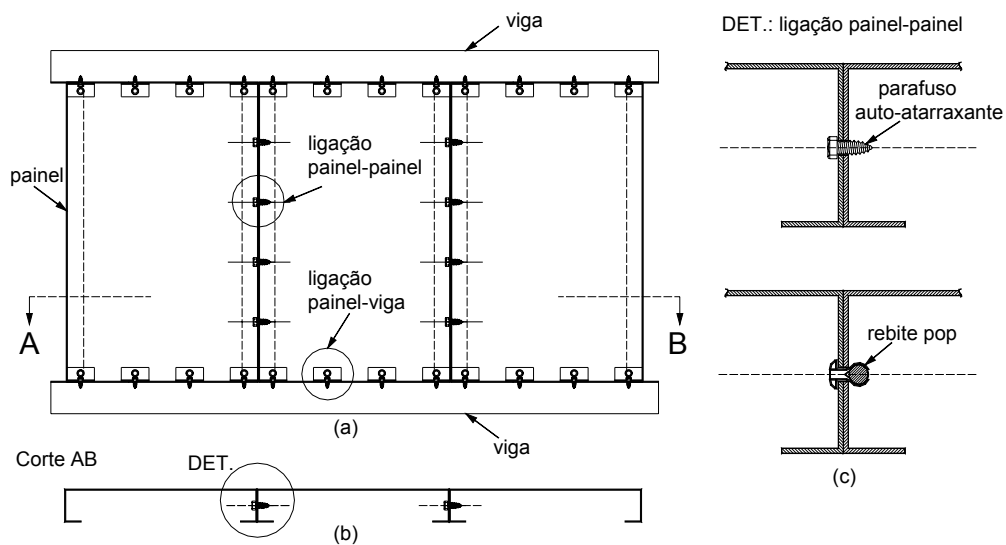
Ligação parafusada dos painéis: (a) vista geral; (b) ligação entre os painéis adjacentes; (c) detalhes de ligações parafusadas entre os painéis.
